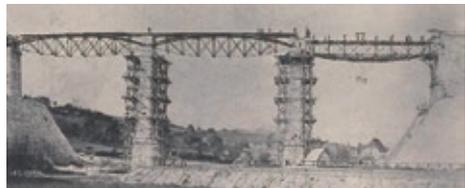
Bauwerk von 1865 mit Fischbauchträgern (Pauliträgern) im Bauzustand Foto: [6]
